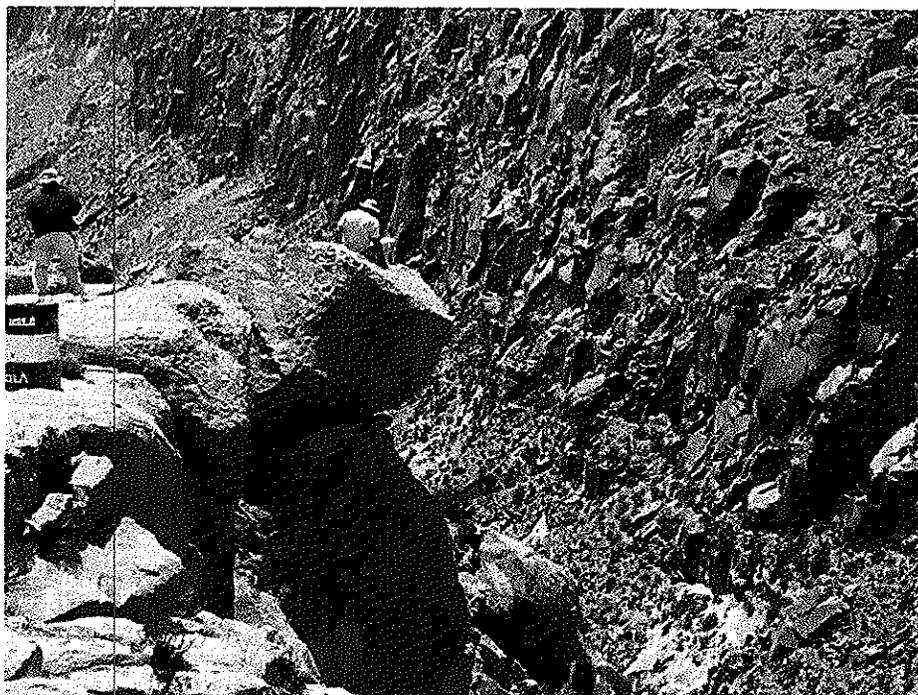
Tubería no instalada, sector Quebrada Honda
